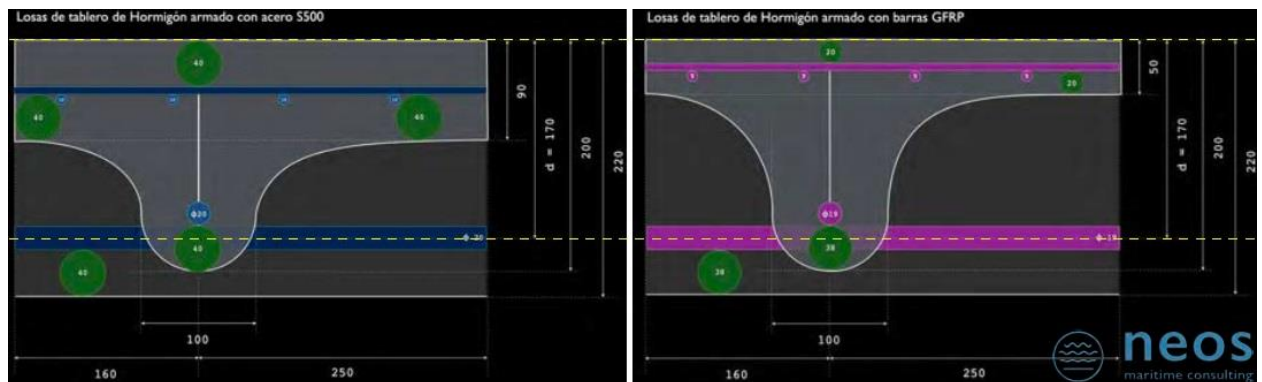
Sección longitudinal de armado inicial y final. (Estructuras de hormigón armado sostenibles e innovadoras, 2024)
